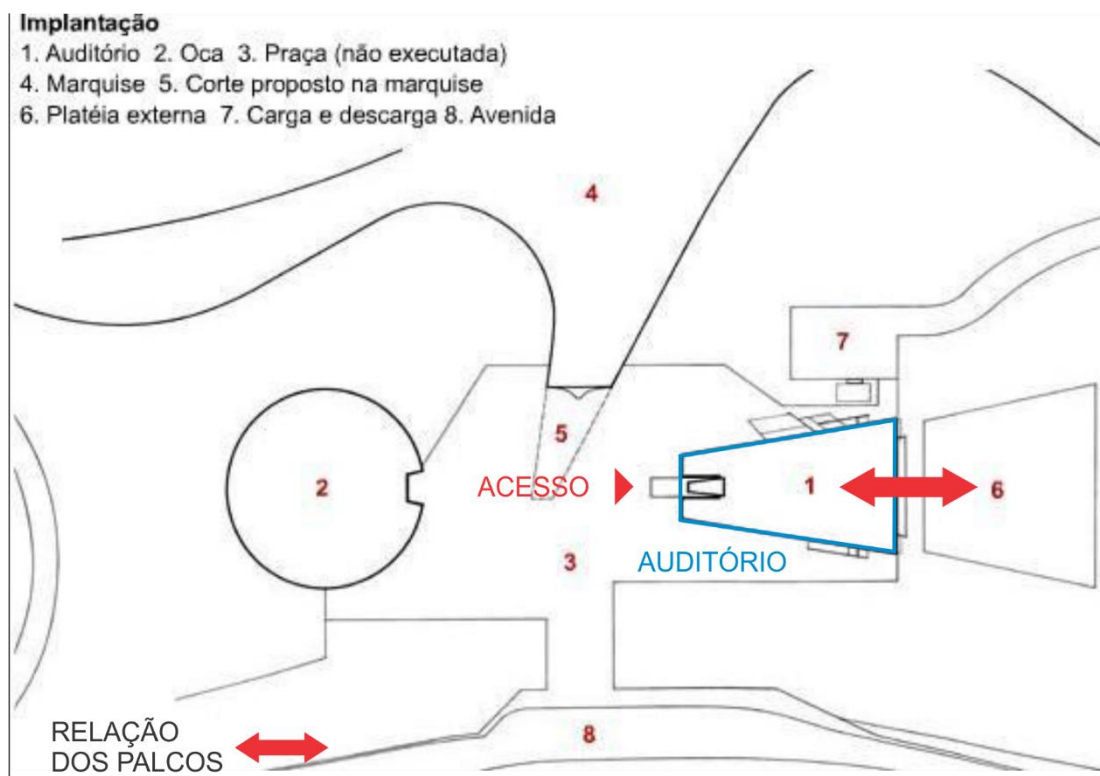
Planta baixa de implantação, Auditório do Parque Ibirapuera
